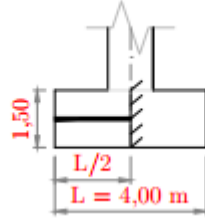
Modelo de cálculo das armaduras da face superior da sapata na direção Y
